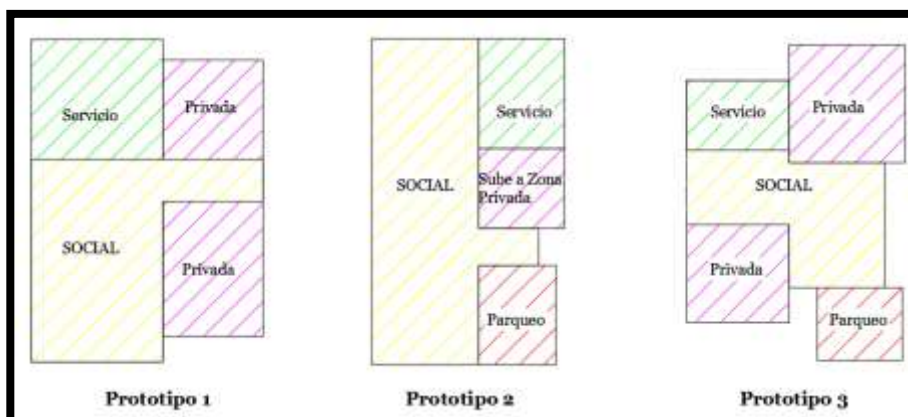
Boceto esquema de zonificación planta baja y alta
